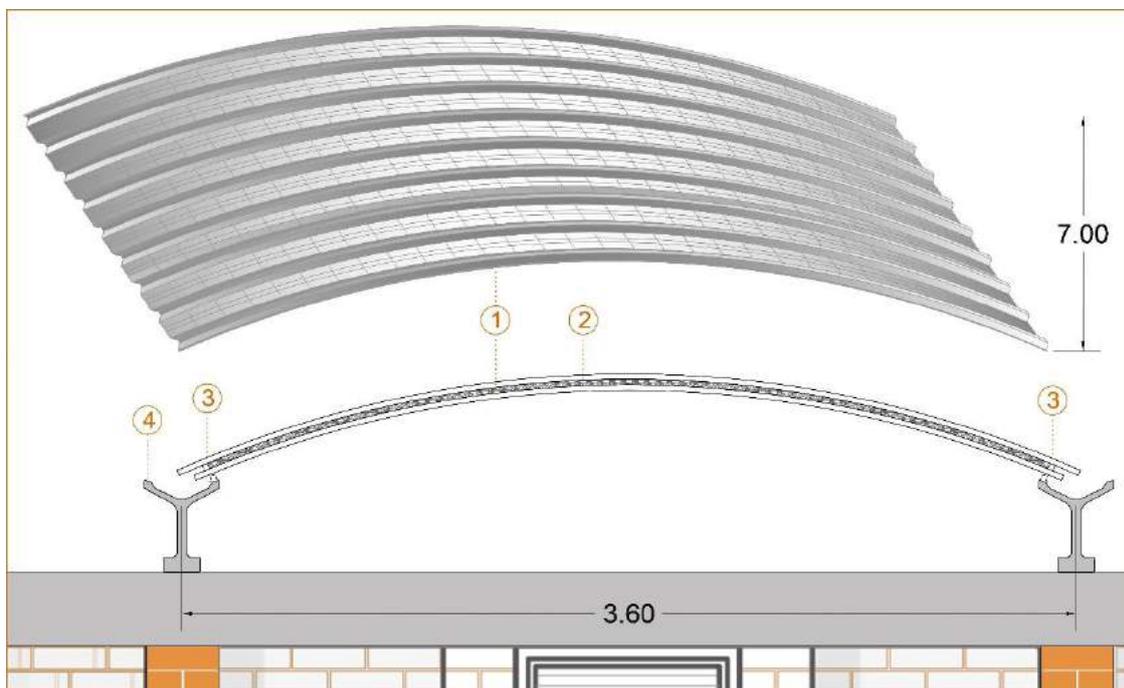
Sistema de cubierta con chapa ondulada + Viga Y. Fuente: Elaboración propia
